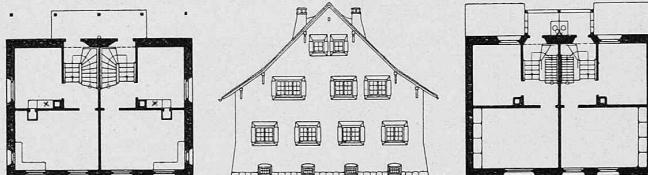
(oben) Ansicht, Abb. 7 Grundrisse und bahnseitige Fassade 1:400 eines Doppel-Einfamilienhauses auf Station Wiesen der Rh. B., erbaut 1911.
